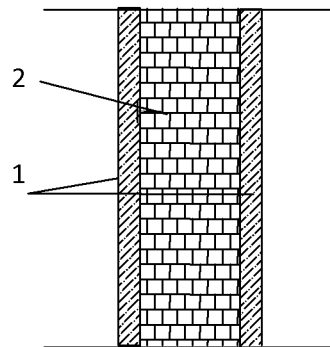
Coupe verticale d'un mur extérieur
